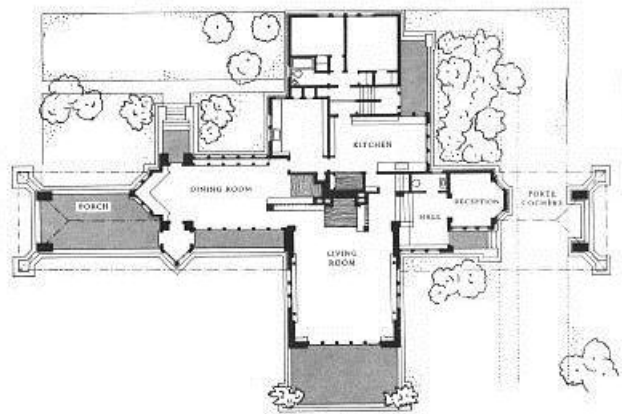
Casa Willits. Planta baja - Frank L Wright.
